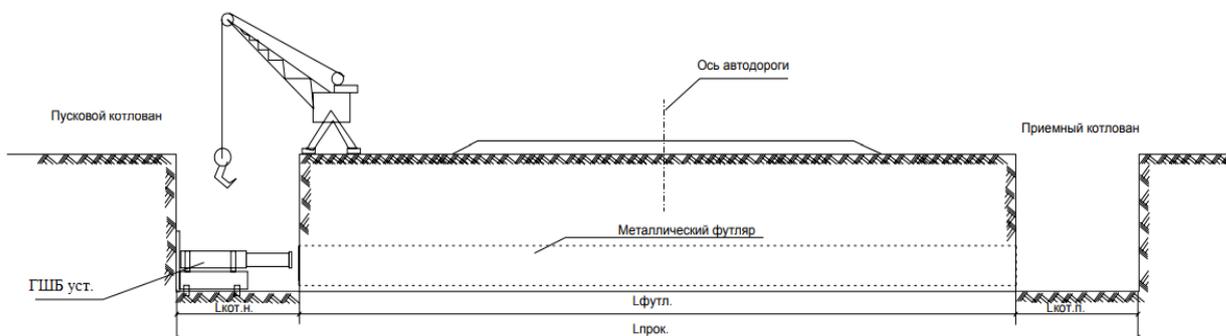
Схема производства работ при прокладке трубопровода методом ГШБ
